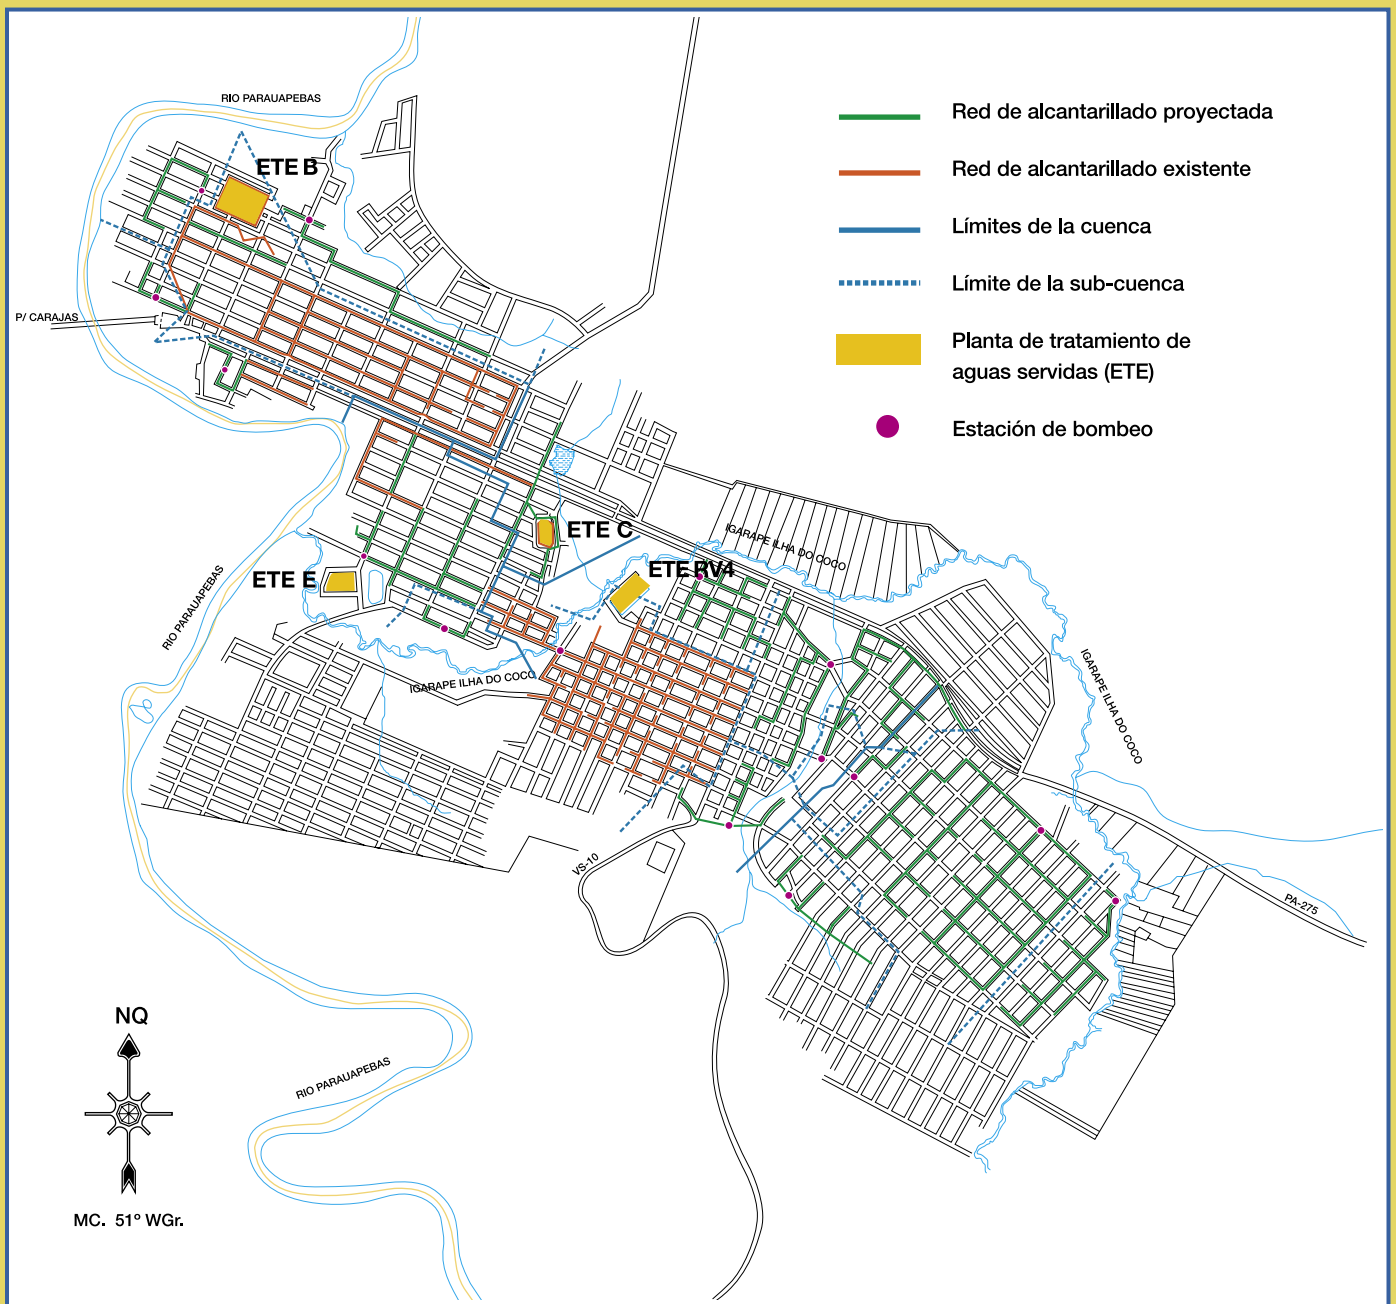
Diseño posterior del sistema de alcantarillado condominial de Parauapebas
